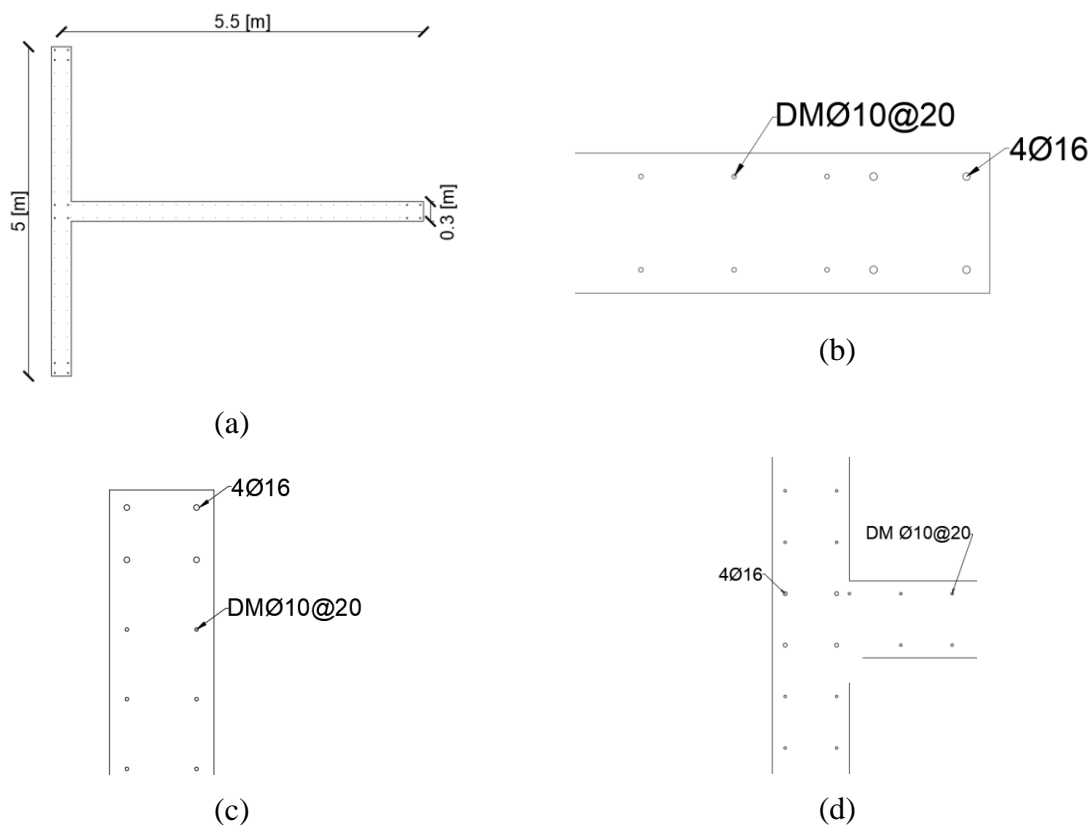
Configuración de refuerzos muro estructura base. (a) sección completa; (b) elemento de borde alma; (c) elemento de borde extremos ala y (d) intersección alma/ala. Pisos 6-15 estructura base.
